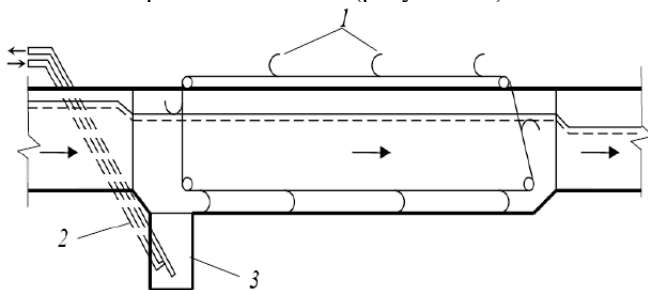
Схема горизонтальной песколовки (продольный разрез):
